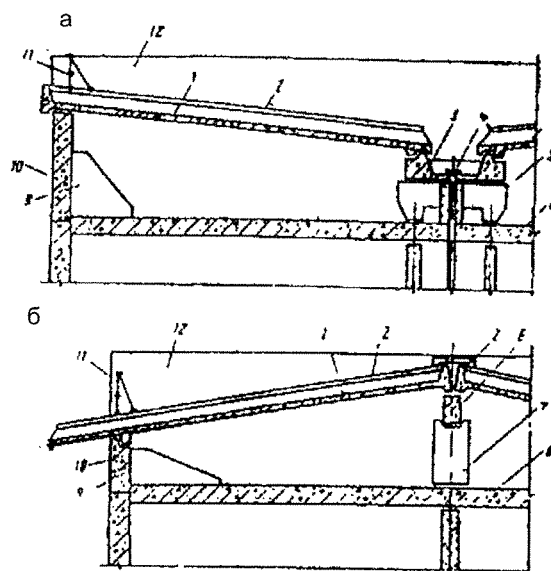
Конструктивные схемы сборных железобетонных безрулонных крыш
